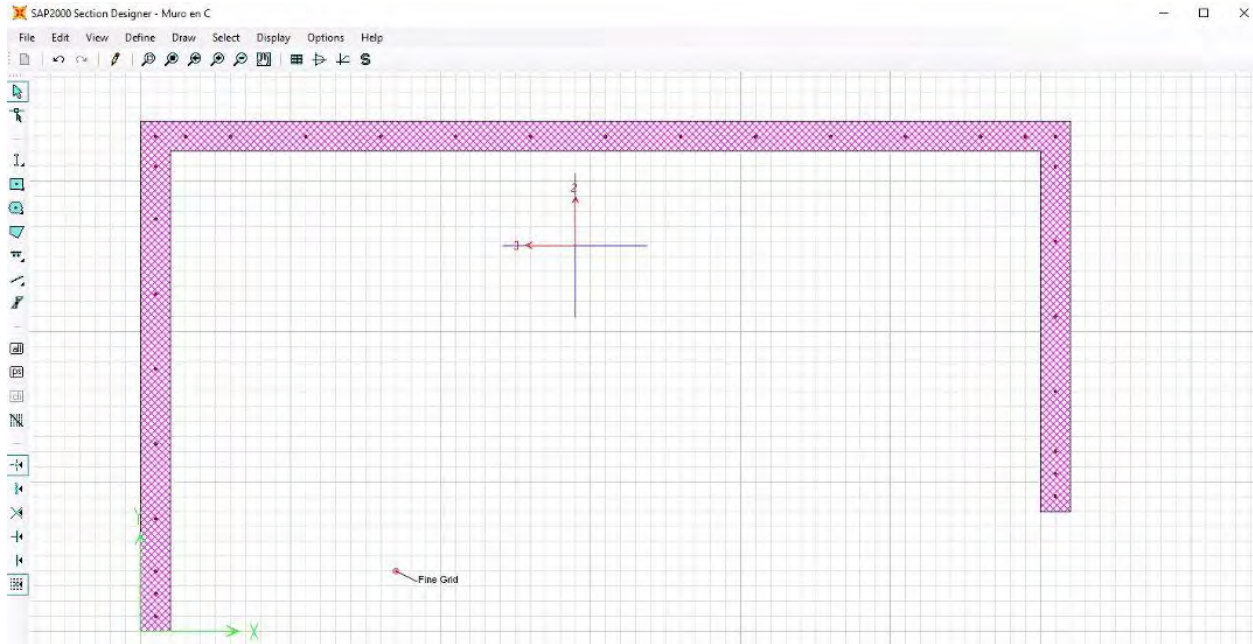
Sección transversal del muro M1 en Section Designer, SAP2000
